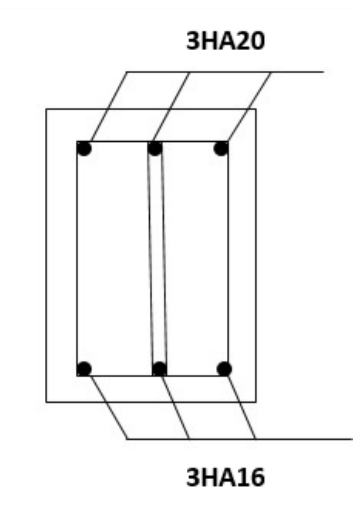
Figure IX.4 Schéma de ferrailage des poutres en appui.
